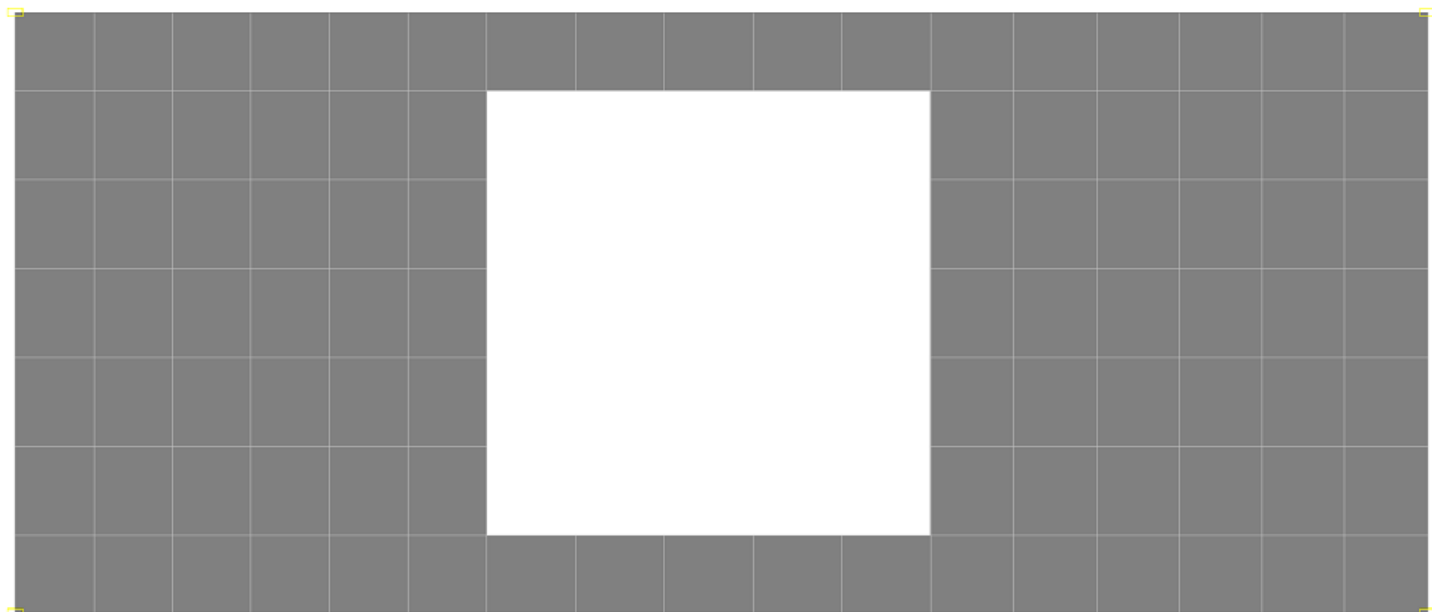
Расчетная схема монолитной плиты перекрытия.
